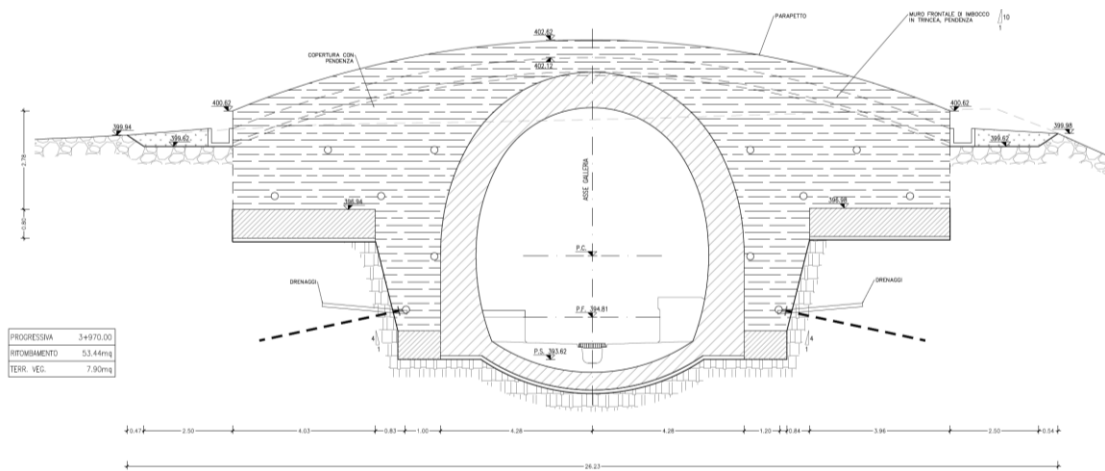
Portale d'imbocco lato Chilivani – Muro di sostegno – Vista frontale
